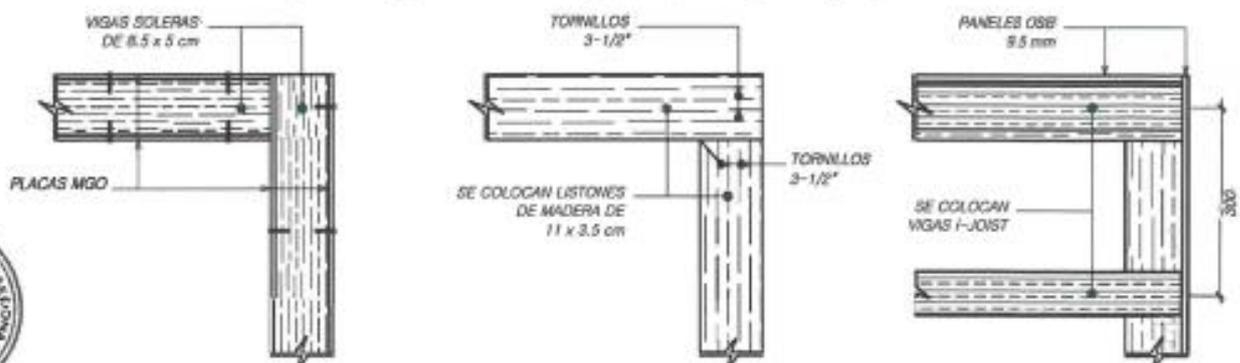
Detalle conexión vigas soleras - vigas inferiores (vista en planta).
